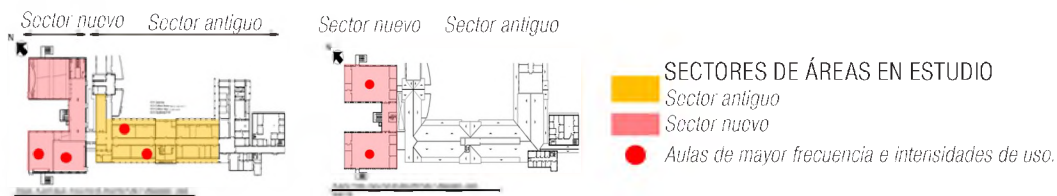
sectores de aulas de la FAU – UNNE. Arriba: Planta baja. Abajo: planta alta.
